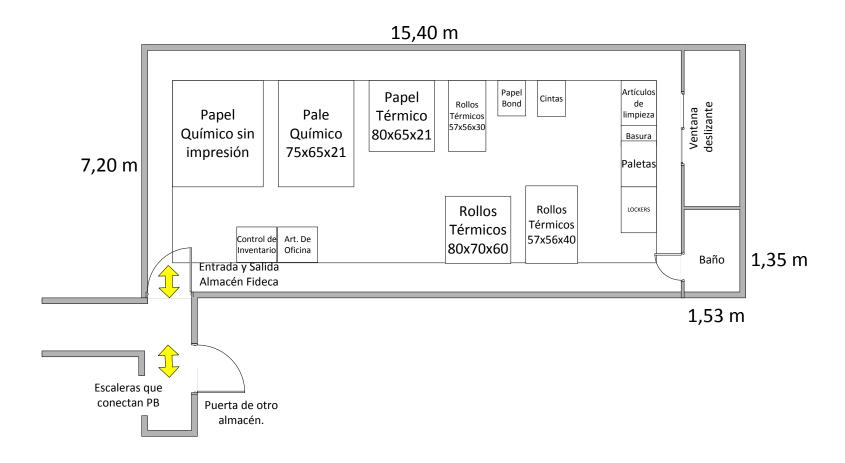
VISTA DE PLANTA DEL ALMACÉN, DONDE SE MUESTRA LA NUEVA DISTRIBUCIÓN.
